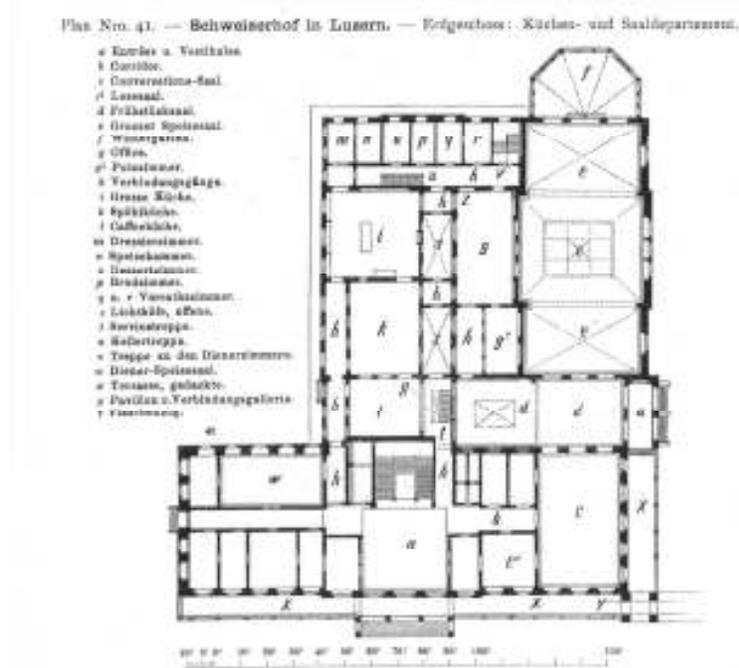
Hotel Schweizerhof, Luzern, Grundriss Erdgeschoss, Küchen- und Saaldepartement.
